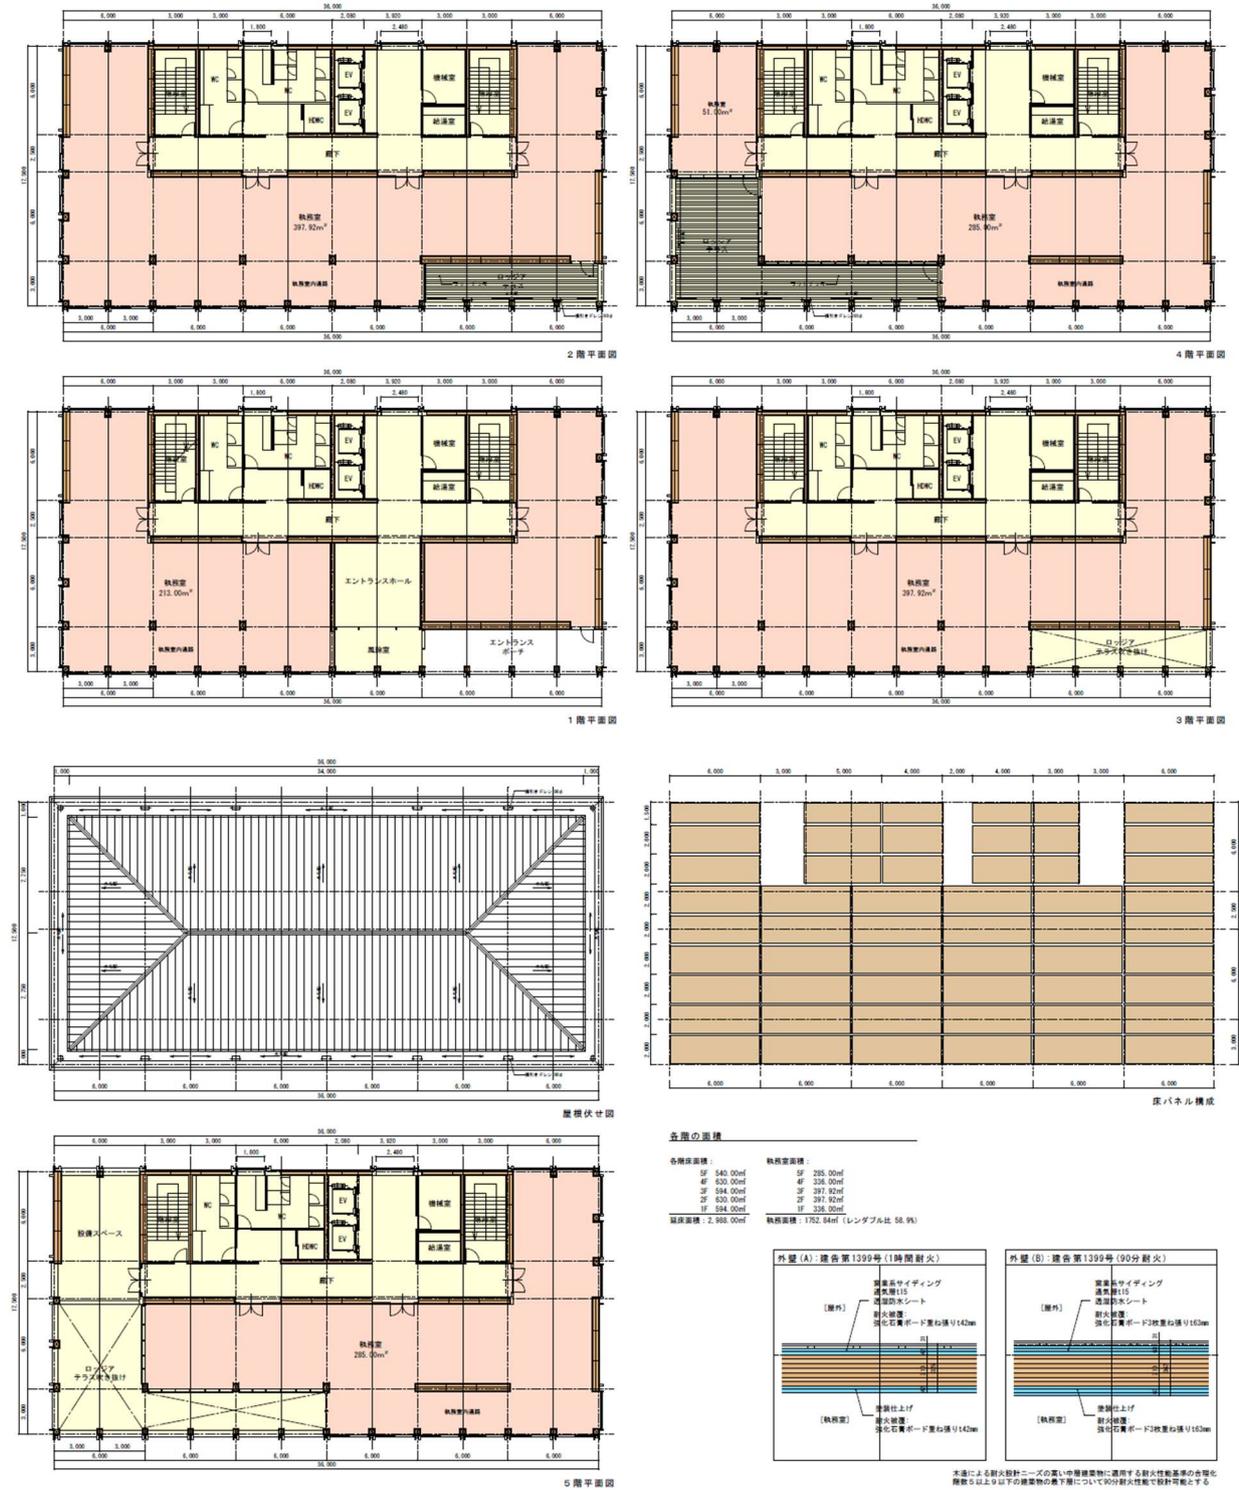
普及モデルの平面図及び床 CLT パネルの構成
